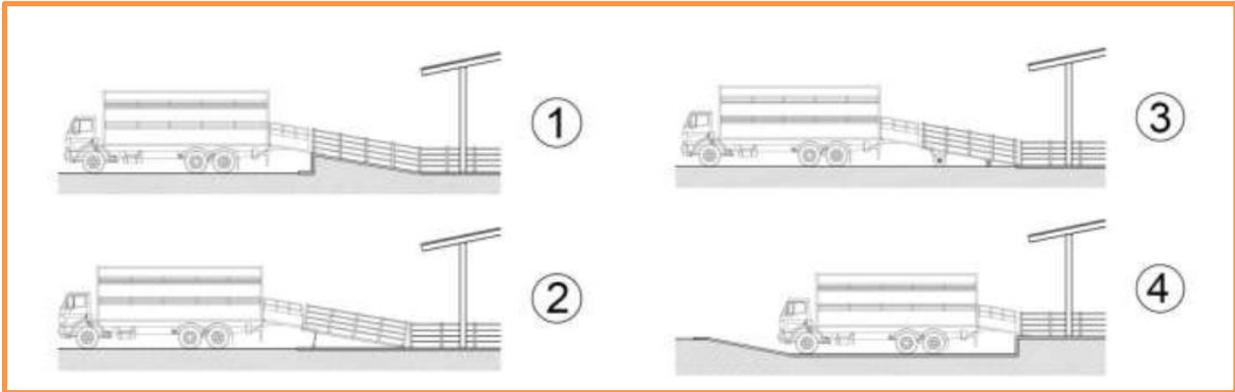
Estructuras posibles recomendadas para (des)cargar animales.
